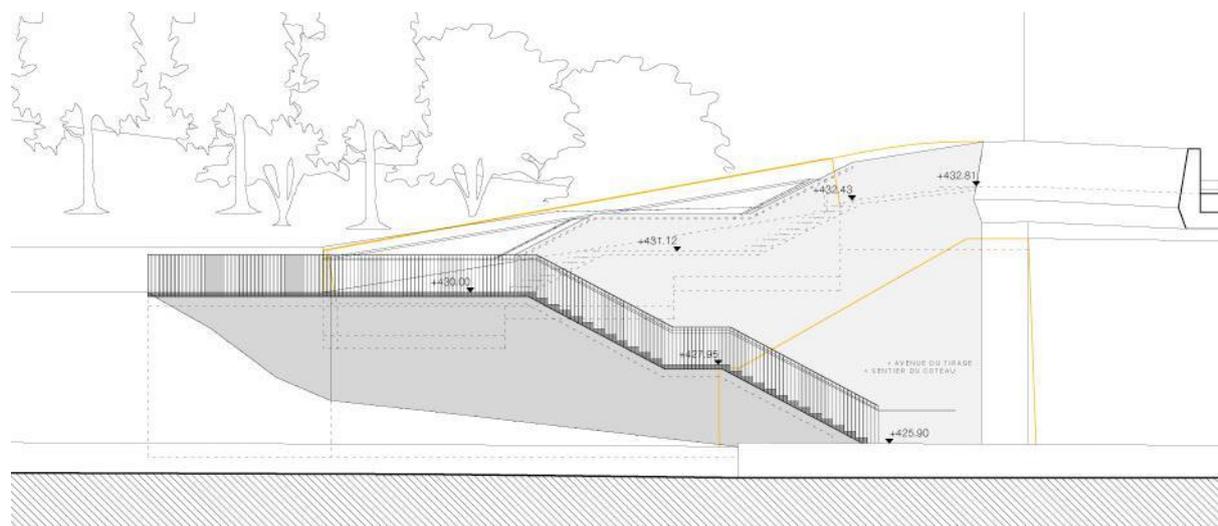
Accès Nord-Ouest _ élévation Sud _ échelle : 1/200
